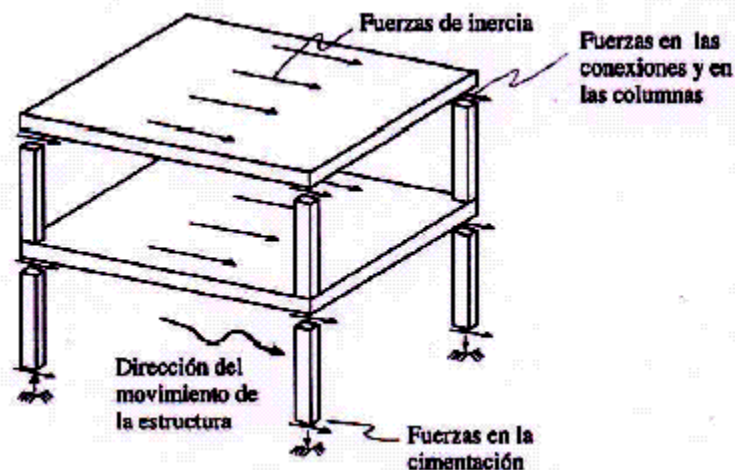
FLUJO DE FUERZAS EN LA ESTRUCTURA DEBIDO A LA VIBRACIÓN
